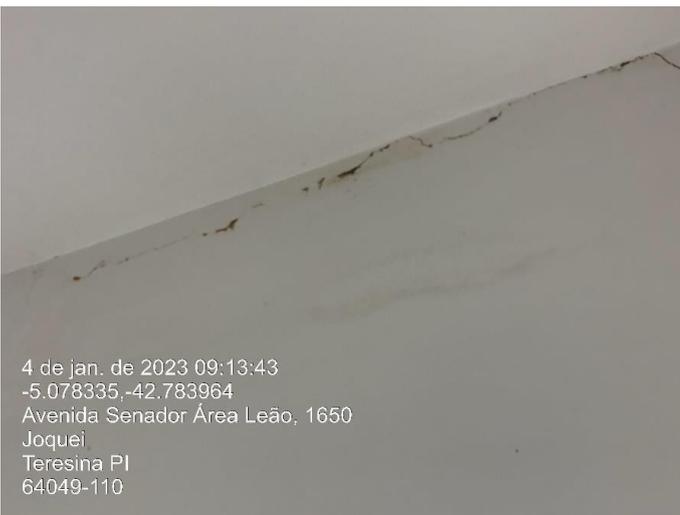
,36: Rachadura estrutural e ponto de infiltração pelo forro
